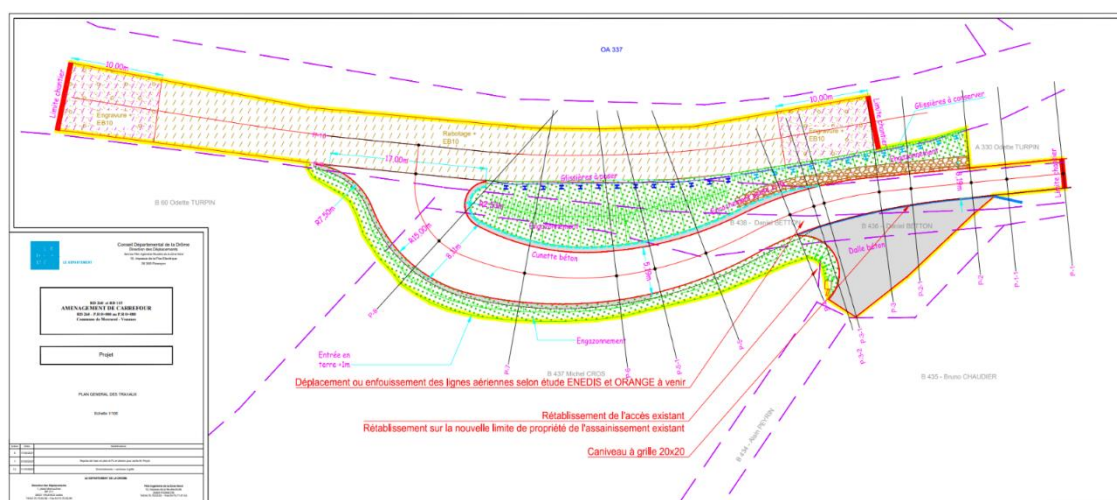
Plan général des travaux au 1/100 - Mercurol-Veaunes
